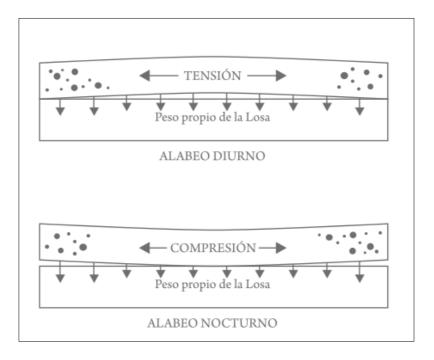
Alabeo de las Losas de los Pavimentos de Concreto
